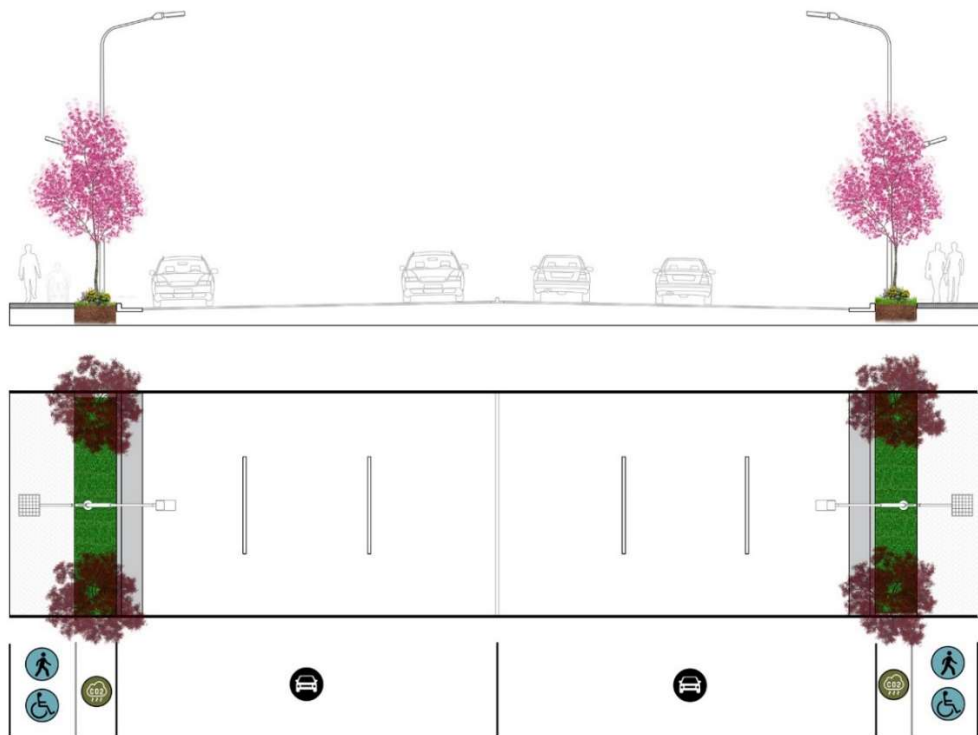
PERFIL CON CARRILES DE GIRO A LA IZQUIERDA.
